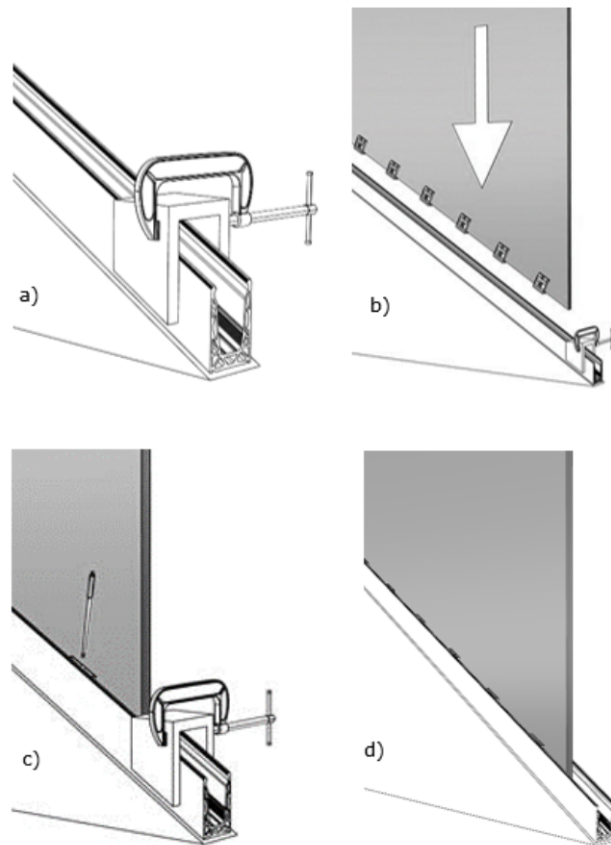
Installation en rampant du système DEFENDER avec calage provisoire a) serrage de la cale provisoire avec serre-joint b) installation du vitrage c) serrage des cales standard d) retrait du calage provisoire
